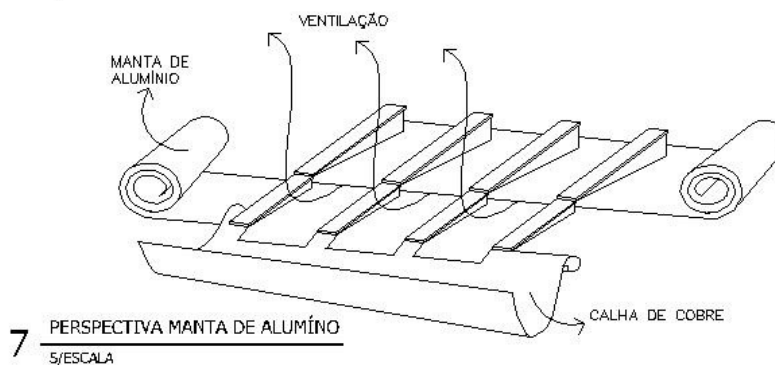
Exemplo de detalhamento executivo da manta de proteção do madeiramento do telhado desenvolvido na fase executiva do projeto de restauração. Projeto de restauração da garagem da Casa de Rui Barbosa. Fonte: Arquivo Bk Arquitetos Associados Ltda.
